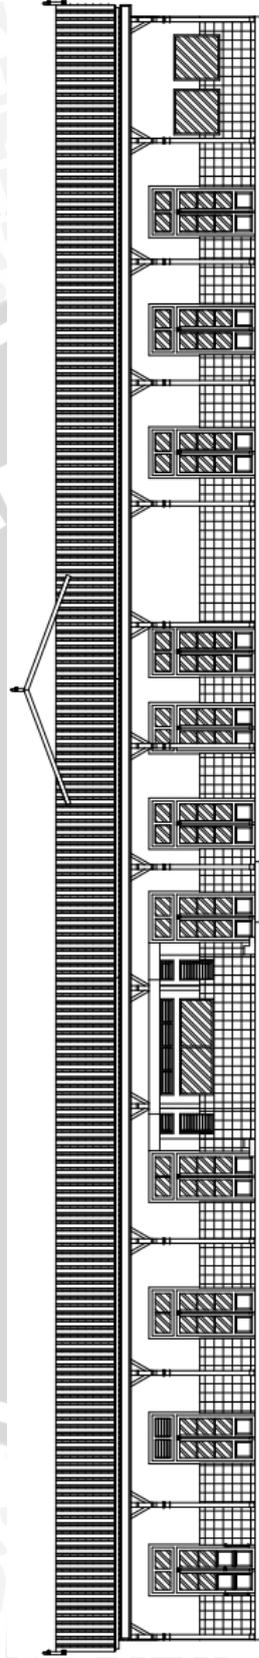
Layout plan Stasiun Jember tahun 2016.
